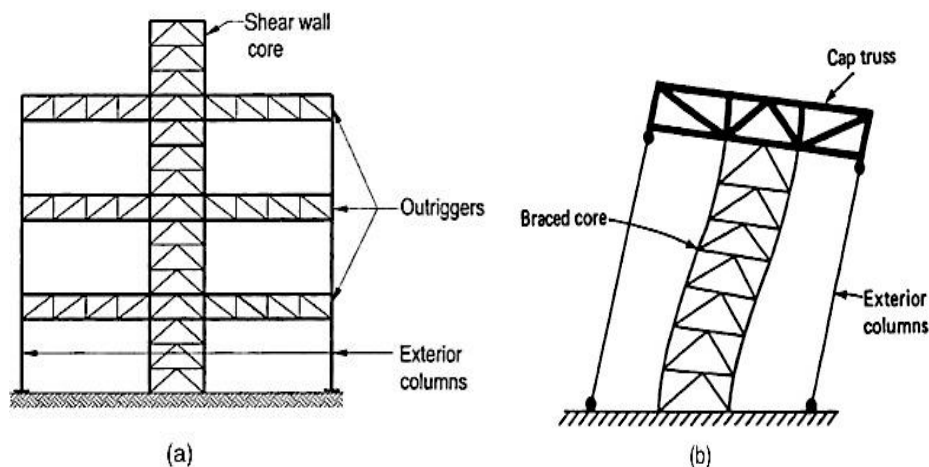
a) Entramado en cinturón con núcleo central y columnas estabilizadoras, b) Respuesta del pórtico arriostrado frente a cargas laterales (Taranath 1998) (7).
